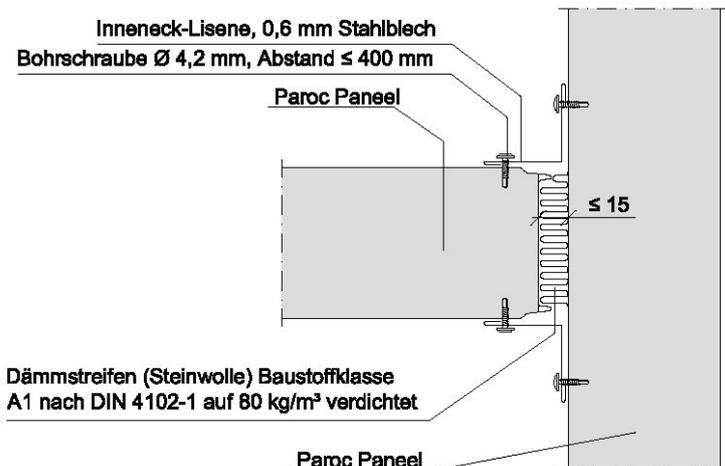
Detail konstruktiver Trennwandanschluss an Wand aus Sandwichelementen
